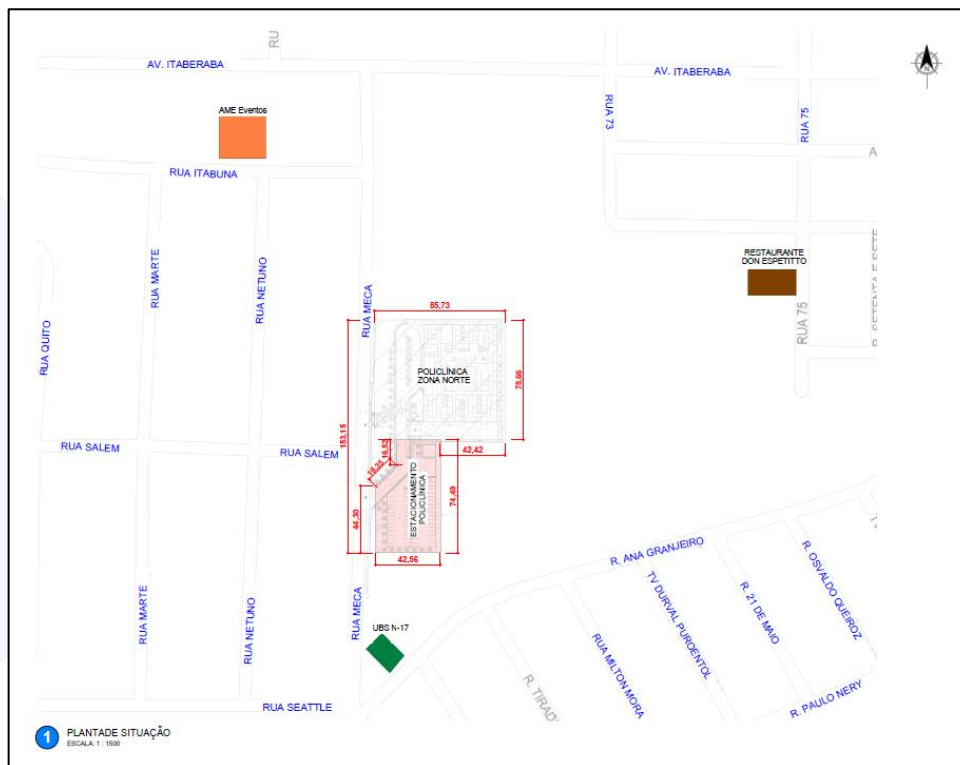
Planta de Localização do Empreendimento. Fonte: Projeto de Situação, 2025.
